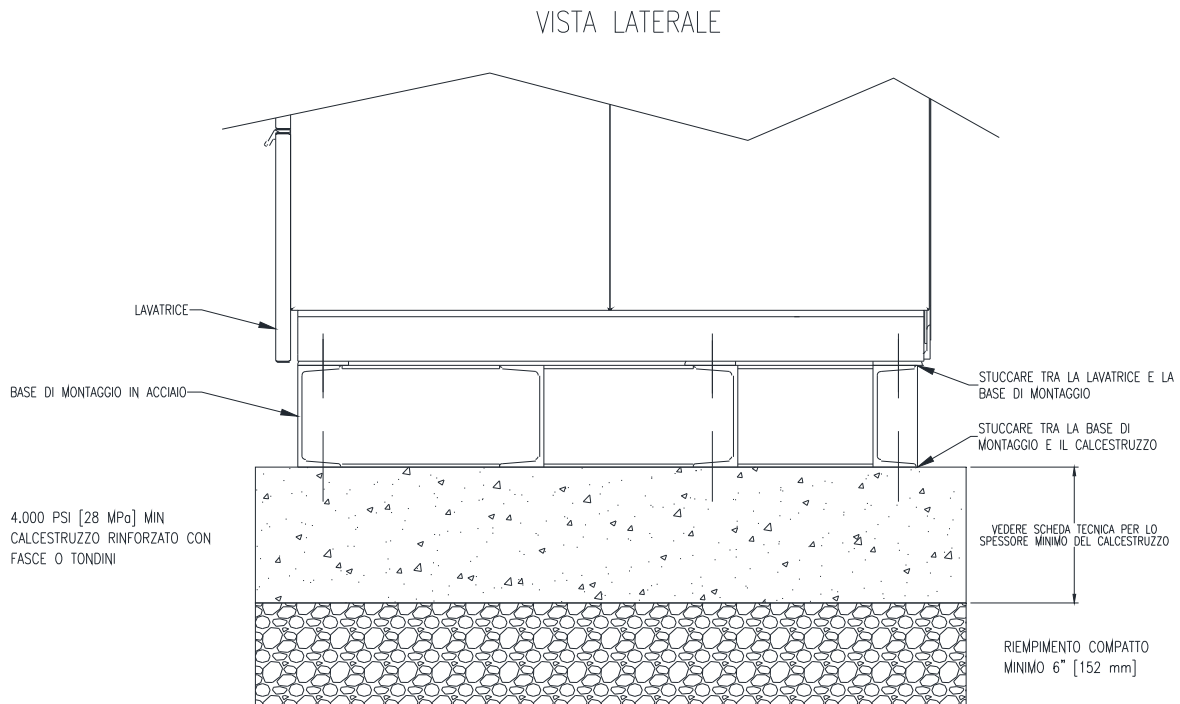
Base di montaggio in acciaio su pavimenti in calcestruzzo
